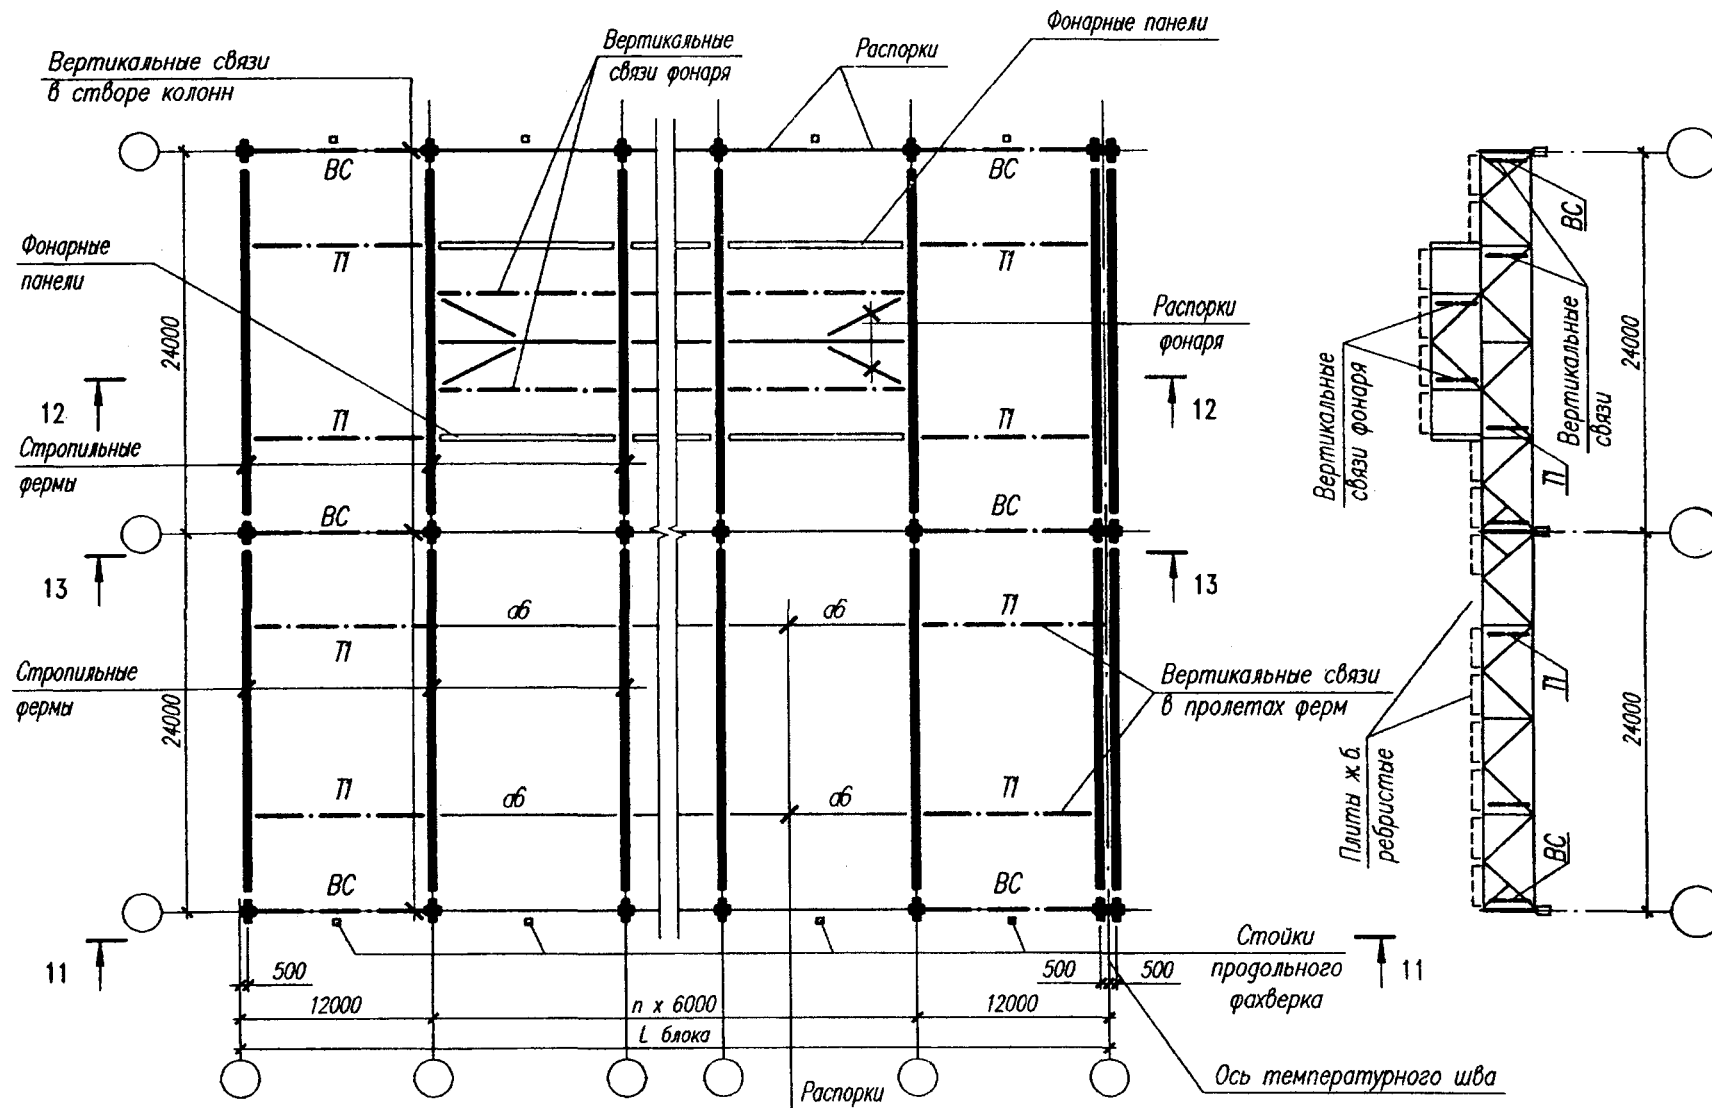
Схема расположения связей по верхним поясам стропильных ферм (шаг ферм 12 м): шаг колонн 12 м по крайним и средним рядам, покрытие из сборных ж/б плит
